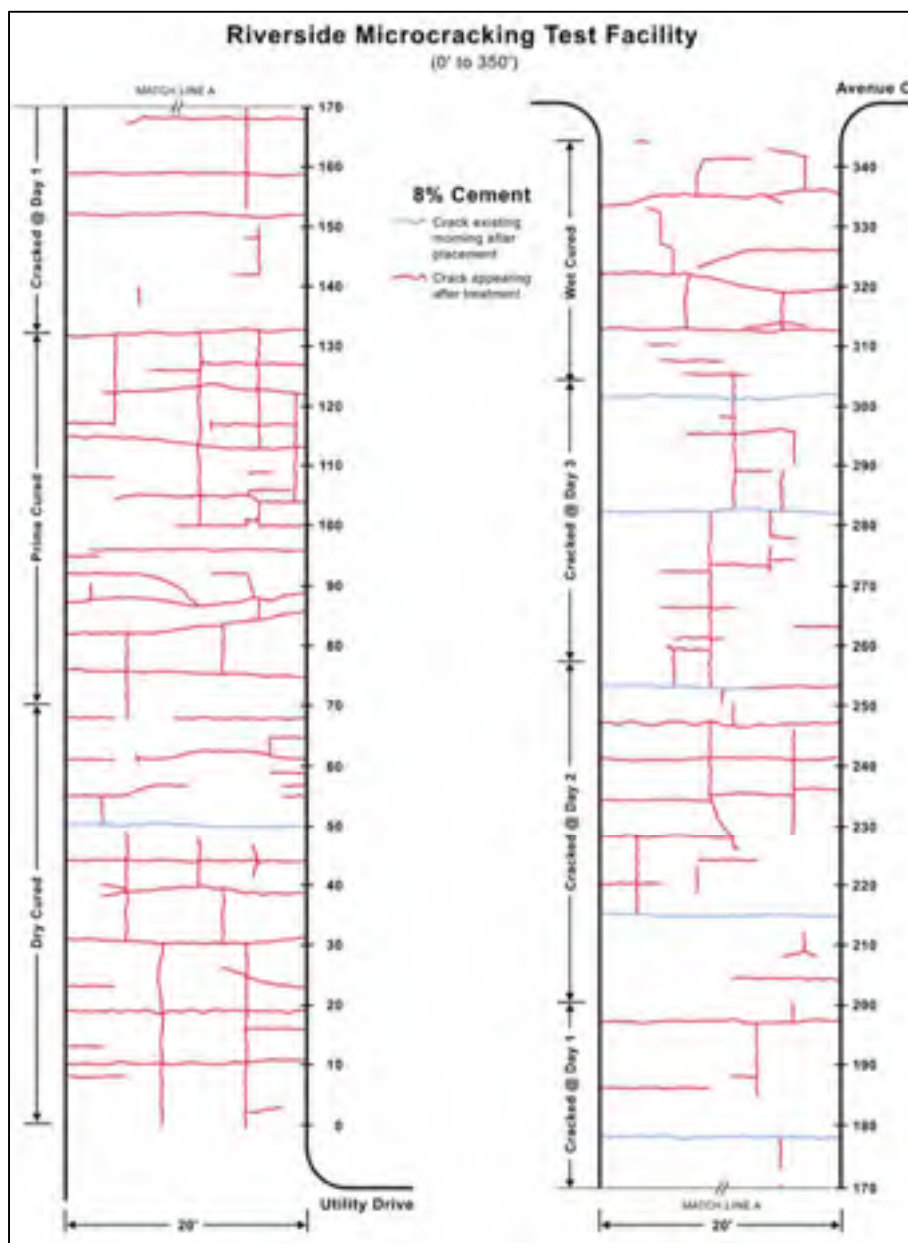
Plan de la fissuration pour section à 8 % (Sebesta, 2005)
